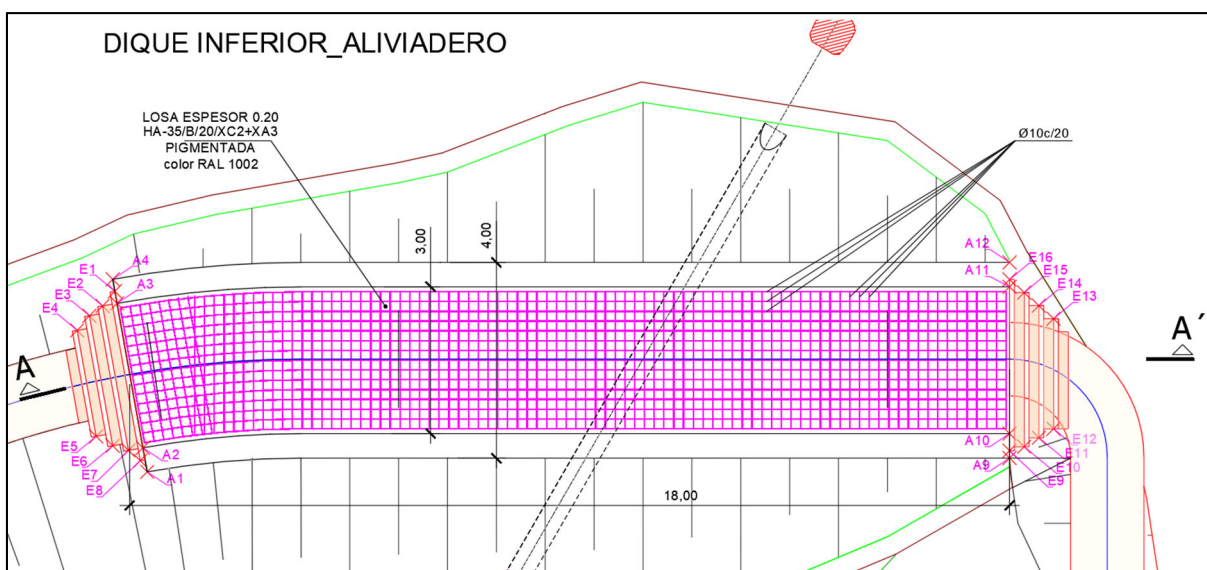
Planta del aliviadero del dique inferior. Losa de 0,20 m de espesor pigmentada. Armadura a una cara de $\varnothing 10c/20$.
